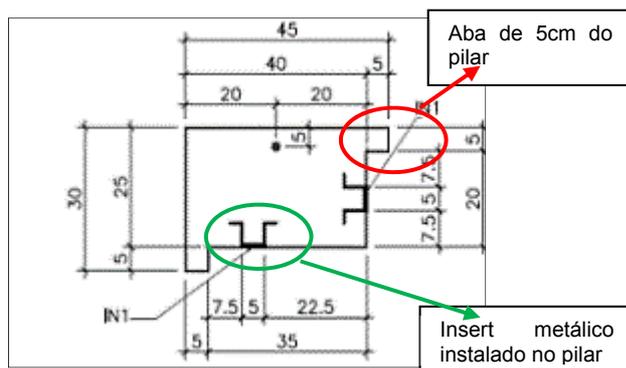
Seção do pilar (detalhe da aba de anteparo dos painéis e insert de ligação embutido no pilar) (medidas em cm)
